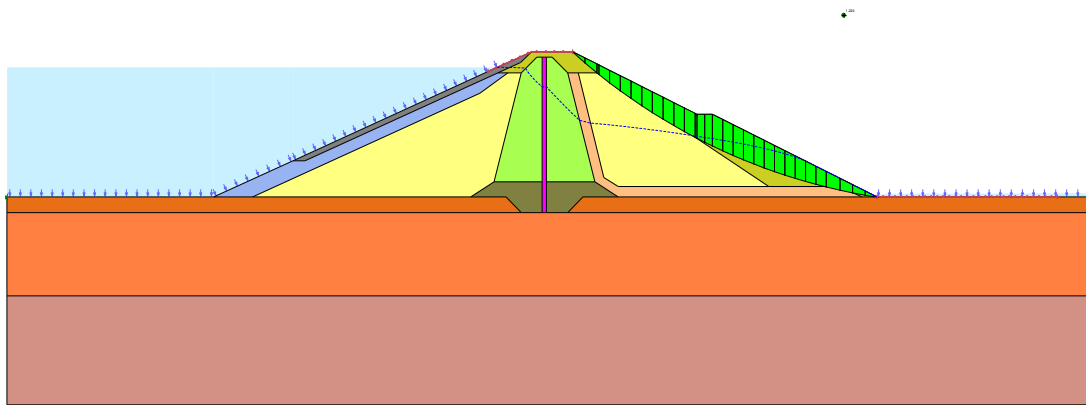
Stabilité – Défaillance du dispositif d'étanchéité et de drainage
